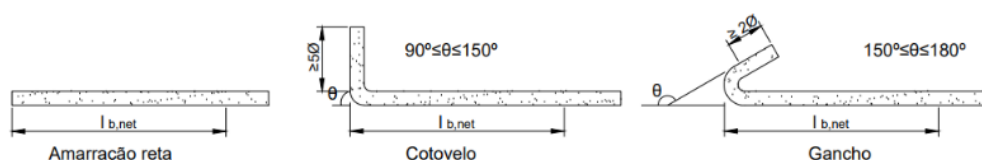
Detalhe das armaduras, adaptado do REBAP.
